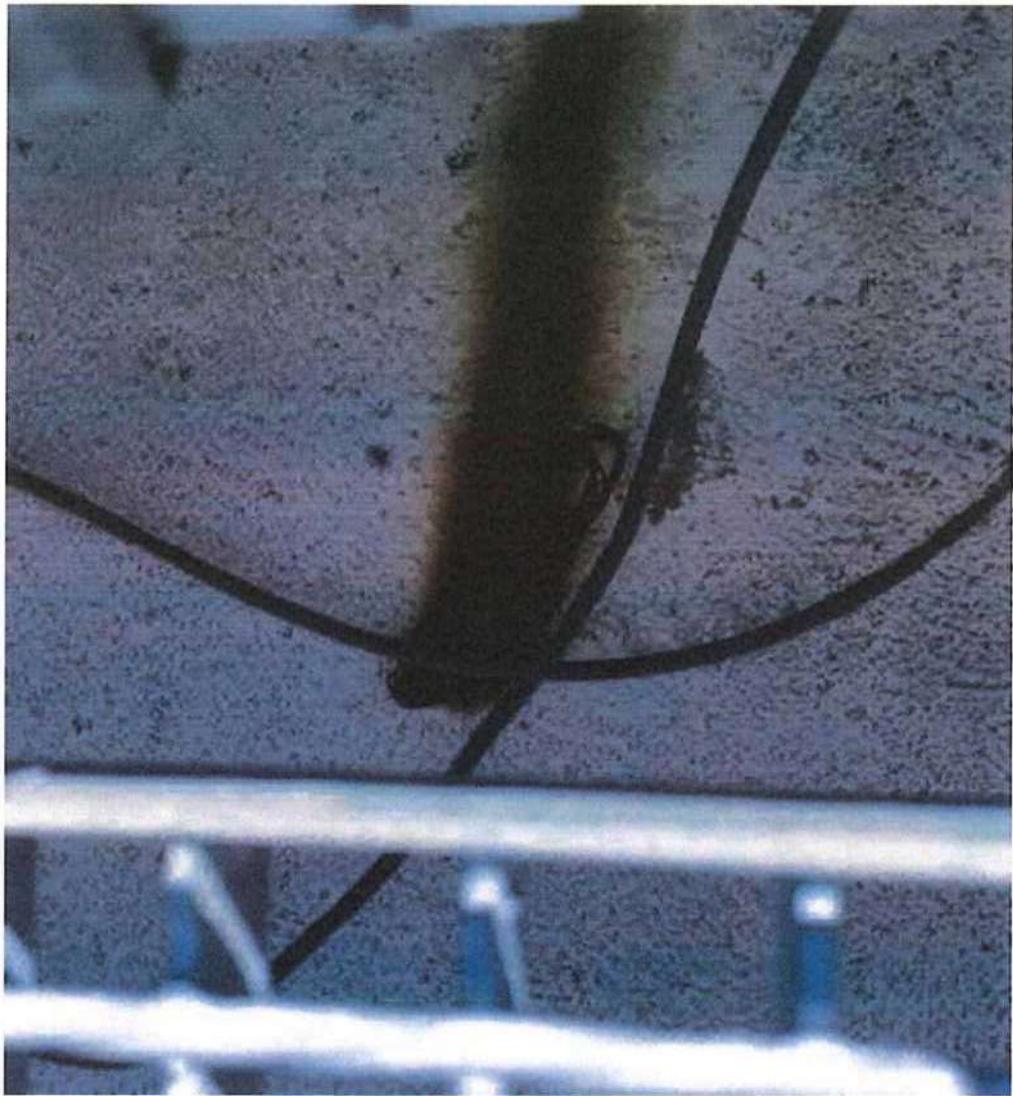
Falta de fusão na junta soldada da tampa do tubo penetrante do segmento 24-25 do anel de compressão
